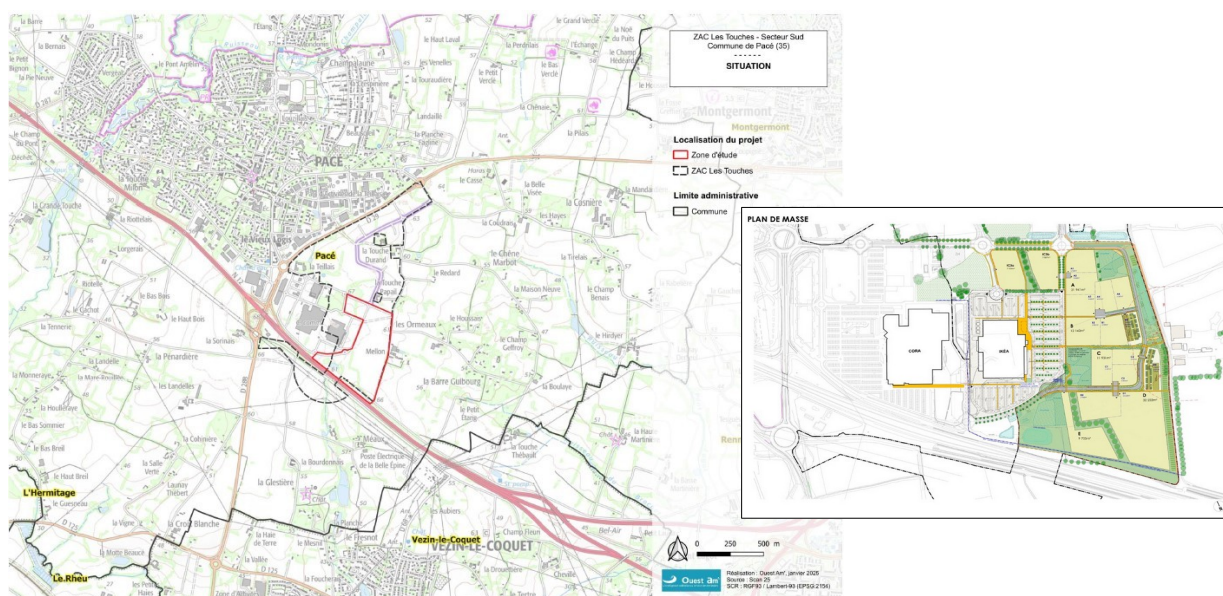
Localisation et plan masse du projet d'extension sud de la ZAC des Touches (source : étude d'impact)
